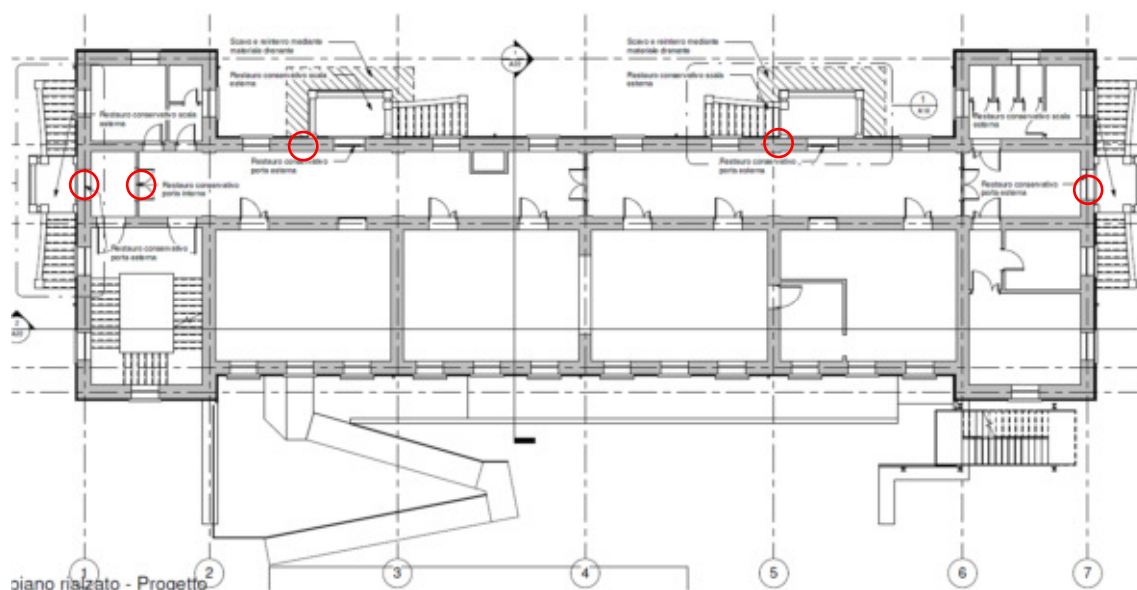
Pianta piano rialzato – Indicazione porte da restaurare
